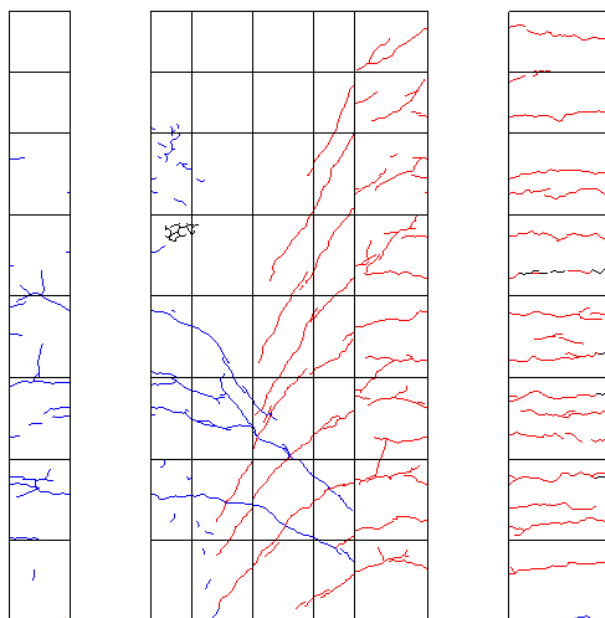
R=-1/100②ひび割れ図
